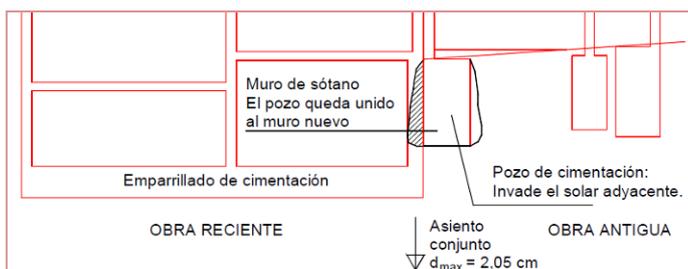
Invasión de cimentaciones próximas. Fisuras y/o grietas
